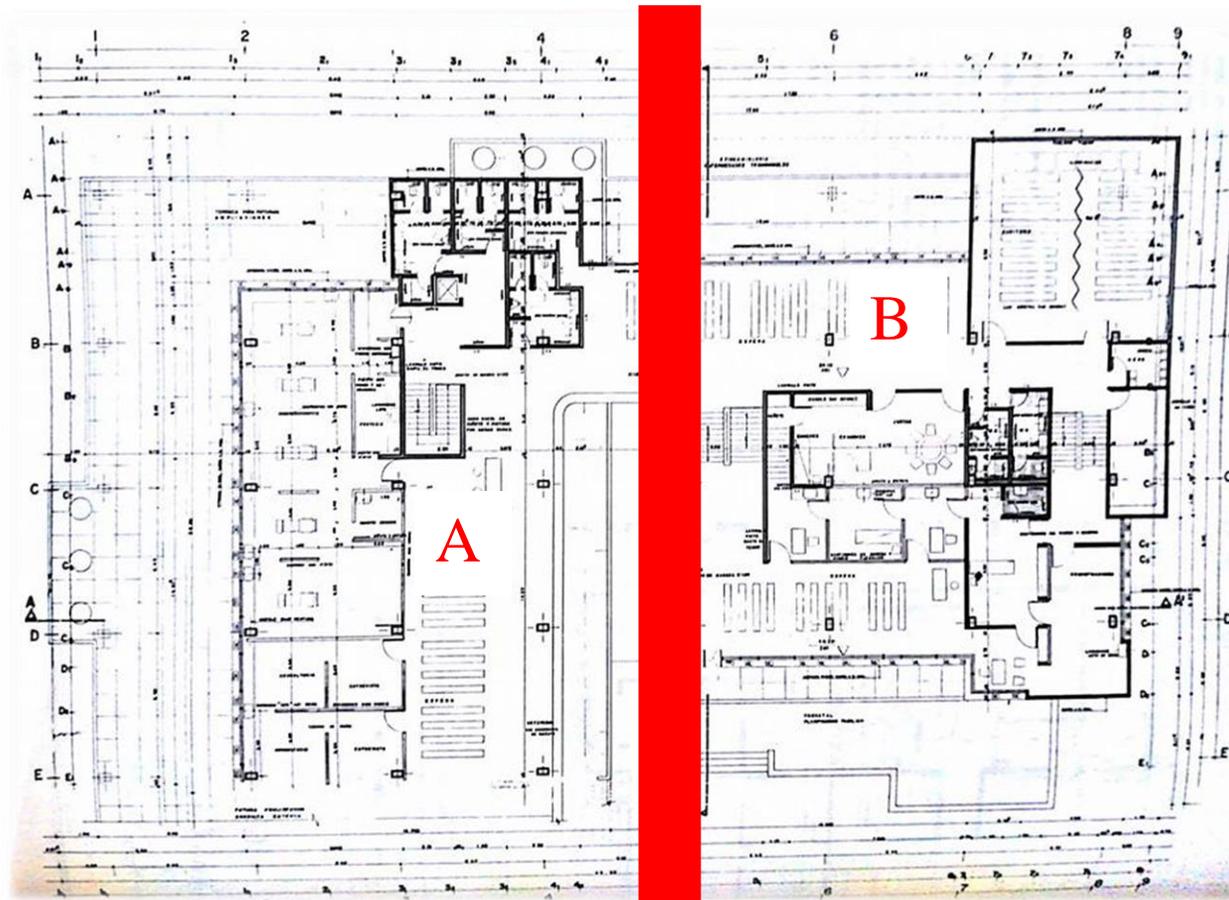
Planta arquitectónica - segundo piso (Revista escala )
